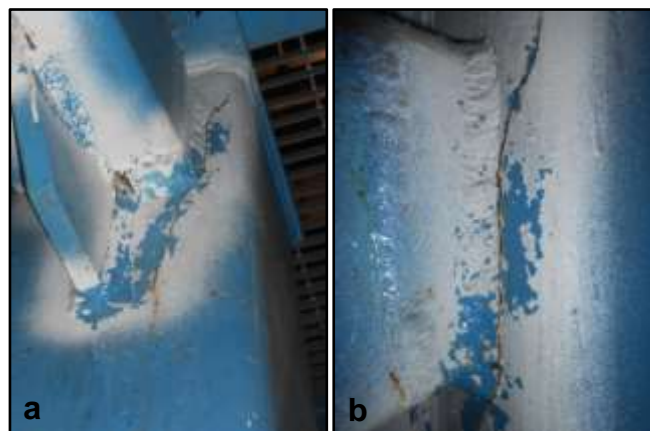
Fisuras encontradas en la unión entre columnas.
